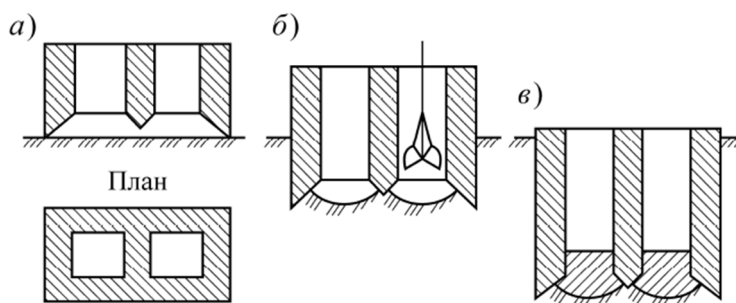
Схема последовательности устройства опускного колодца путем открытой разработки грунта
